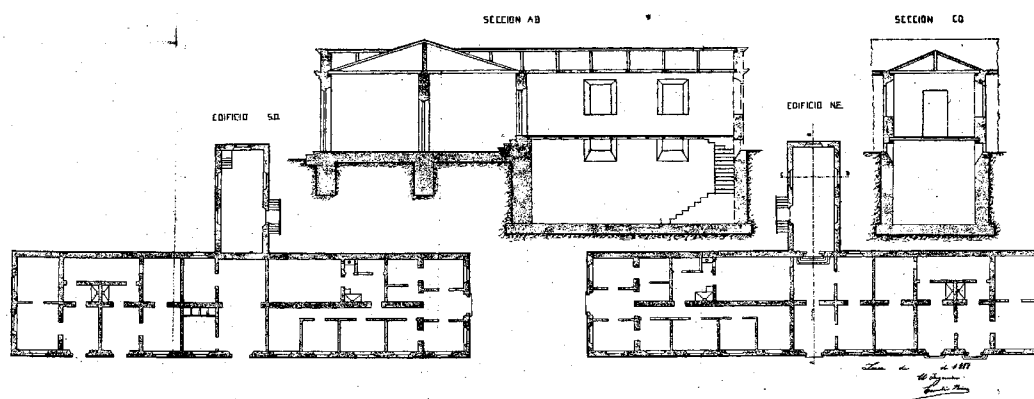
Planta y sección de los pabellones del cementerio. Ingeniero Riera. 1888
